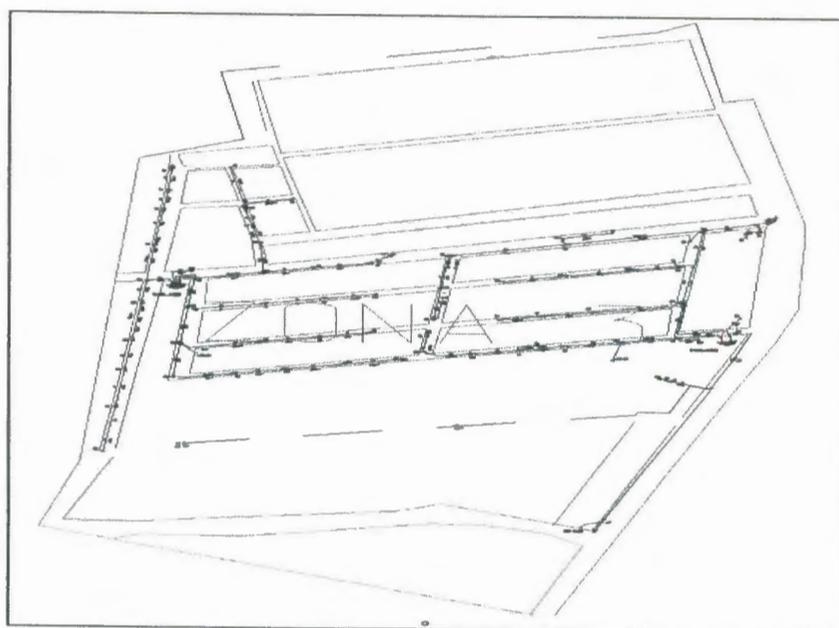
Planimetría zona 3 del sector de la vía a Daule
